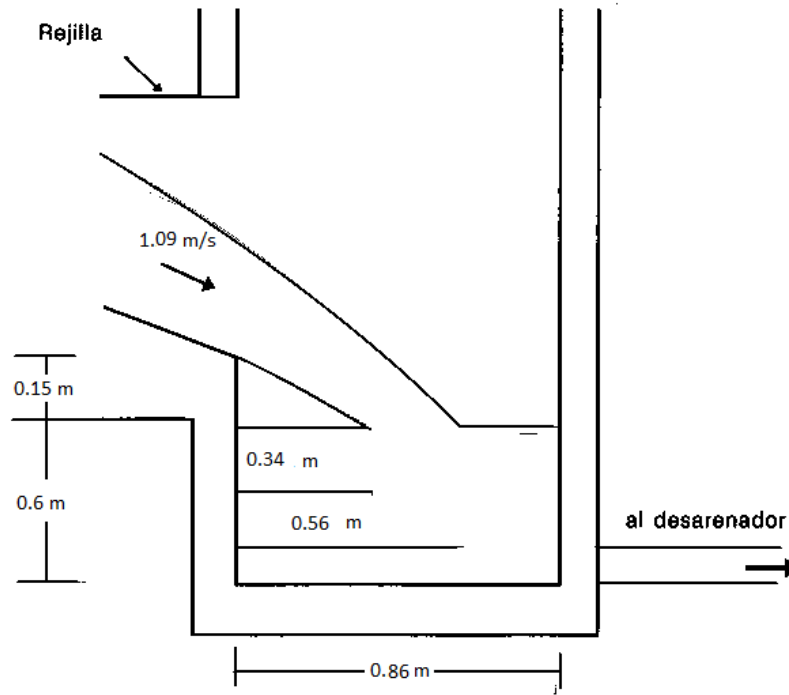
Detallado de la cámara de recolección, modificado de (López Cualla, 2003)
